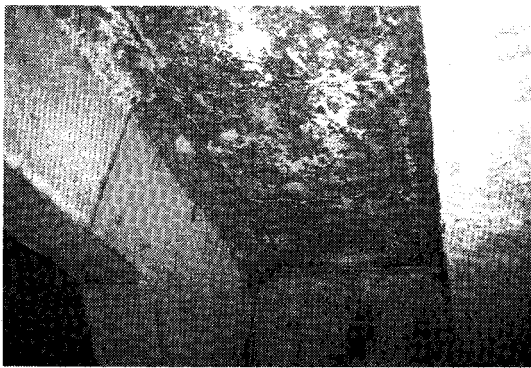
浅野ドックにて建設中の鉄筋コンクリート製円筒構
